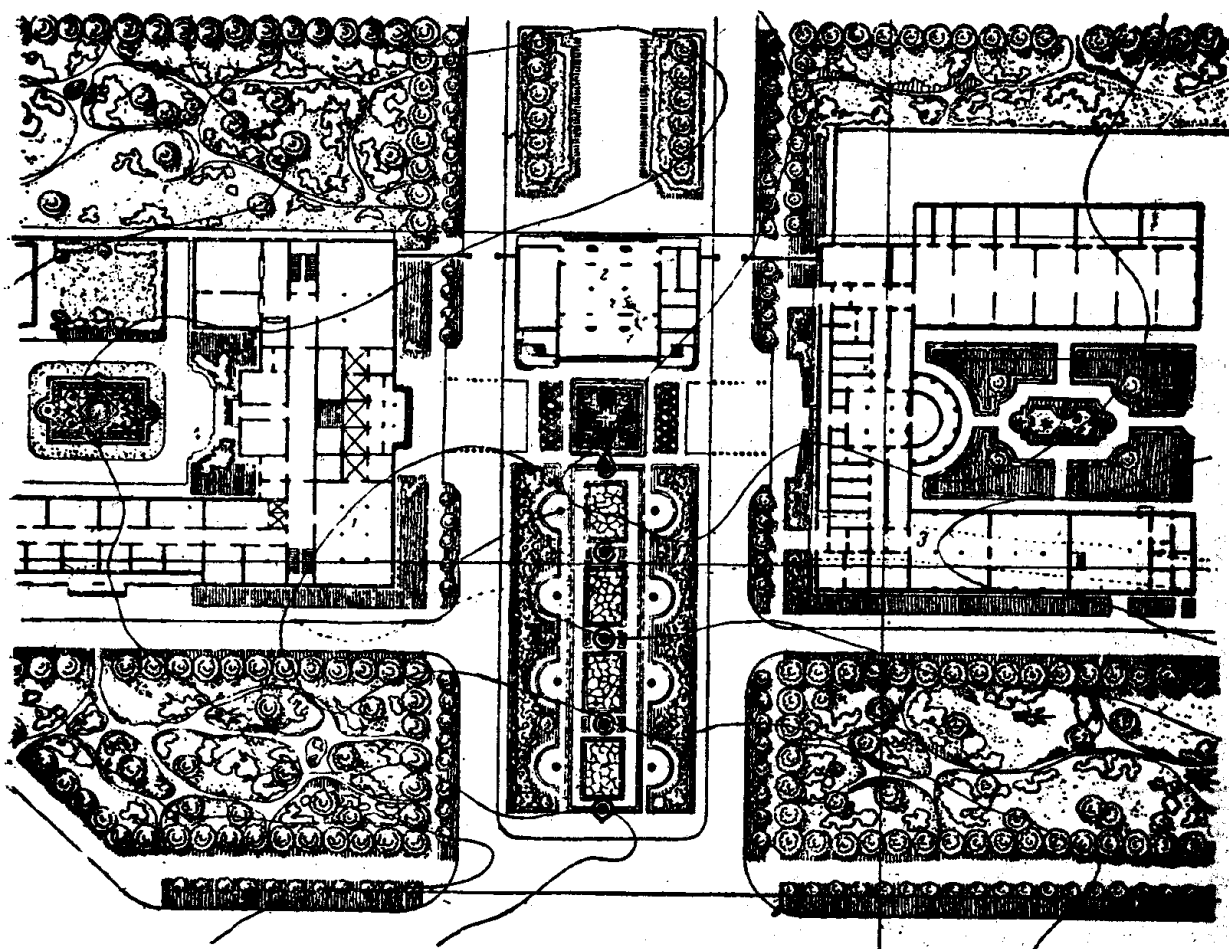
庫塔依西汽車厂的出入口楼，場区的平面布置图
